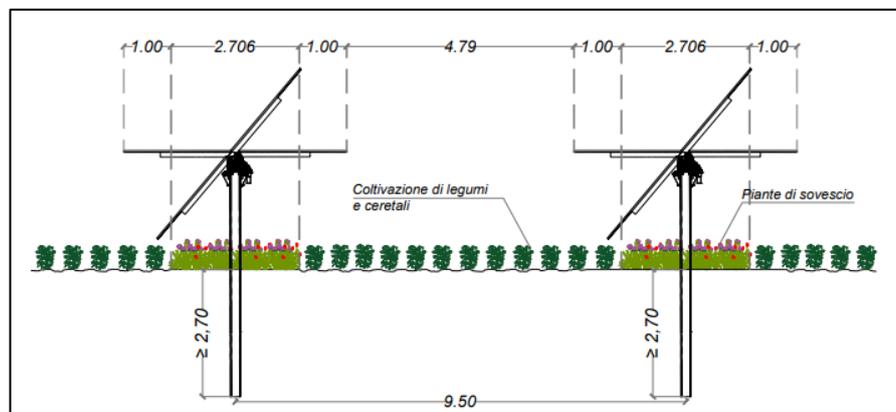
Sezione tipo impianto con file di Tracker – scala 1:25
